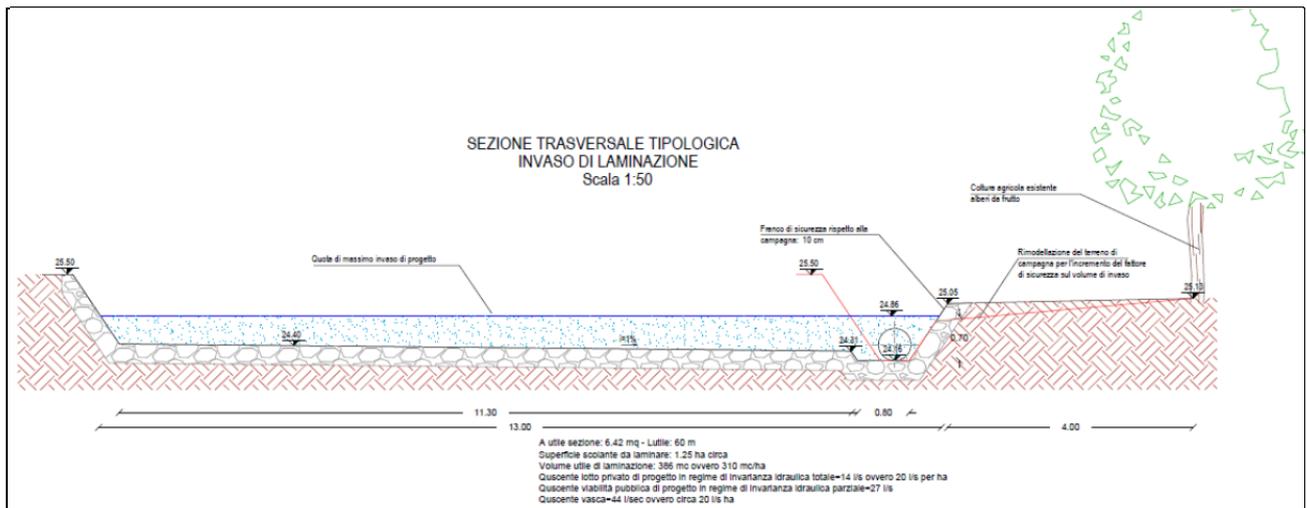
Sezione trasversale della vasca di laminazione a cielo aperto
